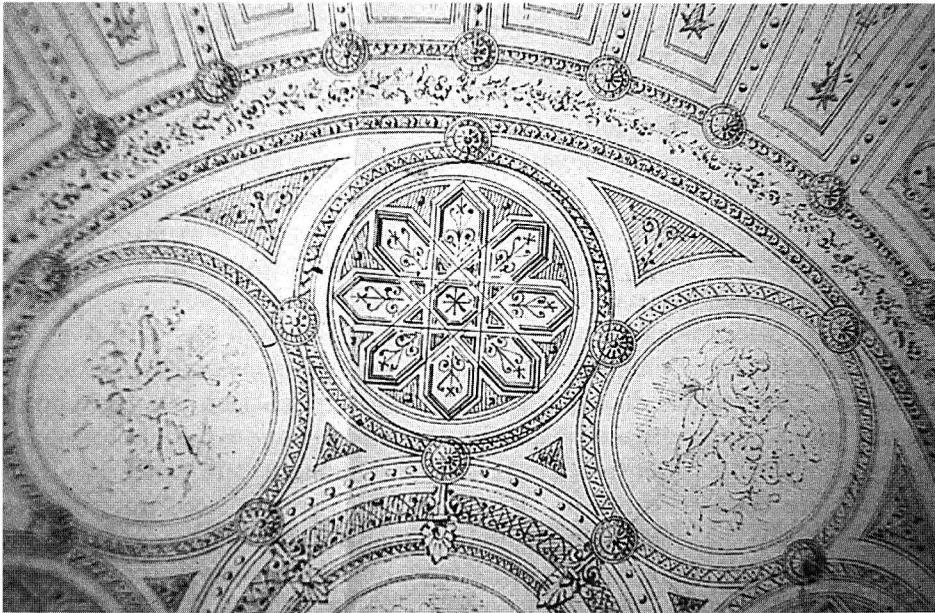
Detalle de la decoración del techo. Dibujo en tinta roja del arquitecto Ricardo Magdalena. Sección de Arquitectura, Ayuntamiento de Zaragoza.
